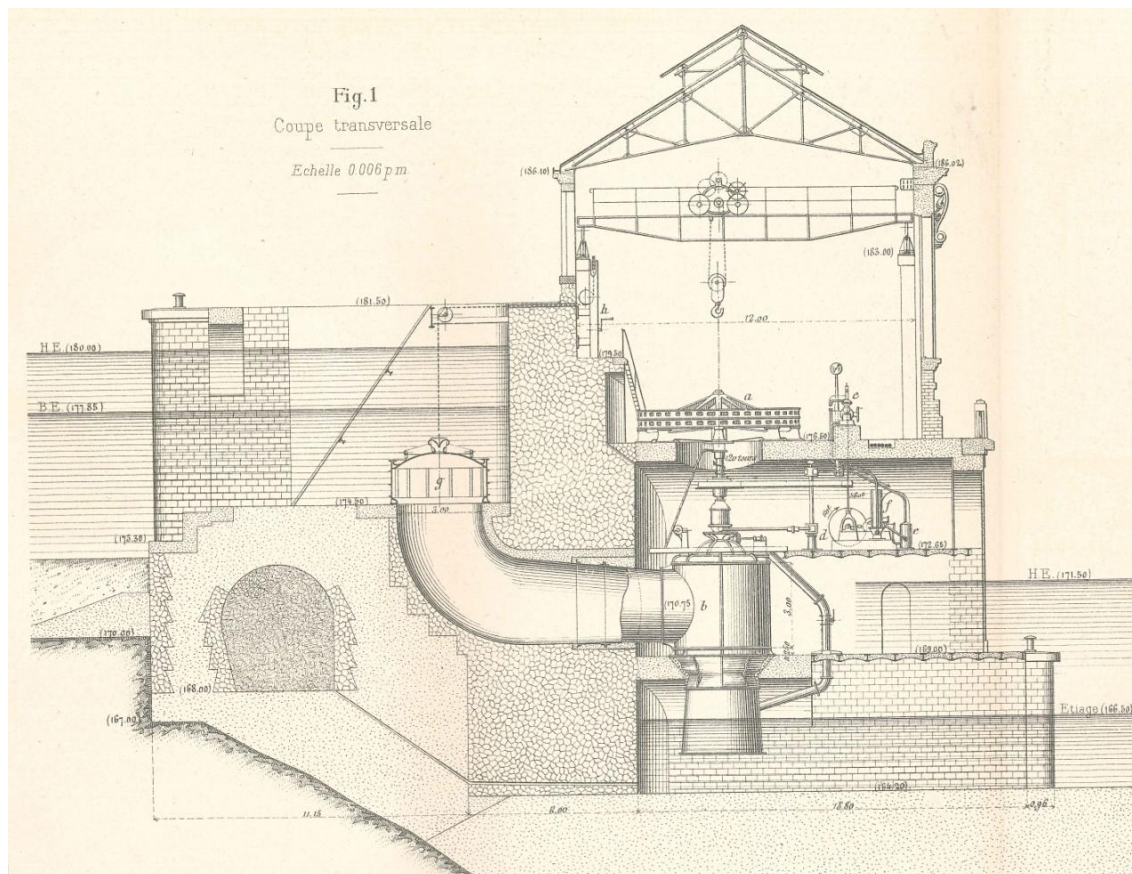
Coupe transversale d'un groupe de 1 250cv (R. Chauvin, *La construction du canal de Jonage*)
